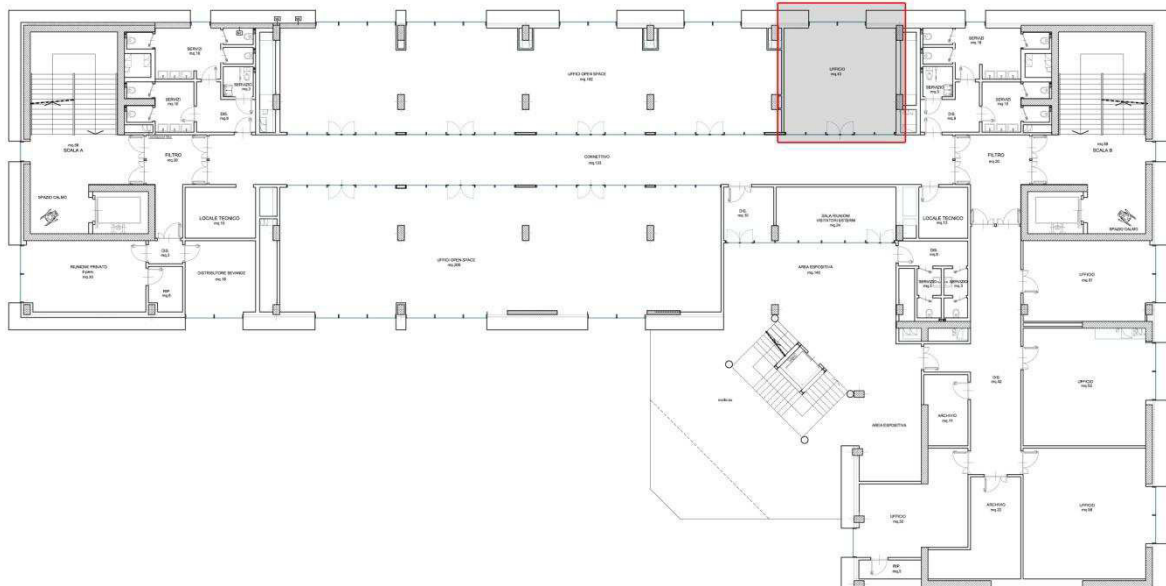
Pianta primo piano con individuazione del solaio analizzato.
